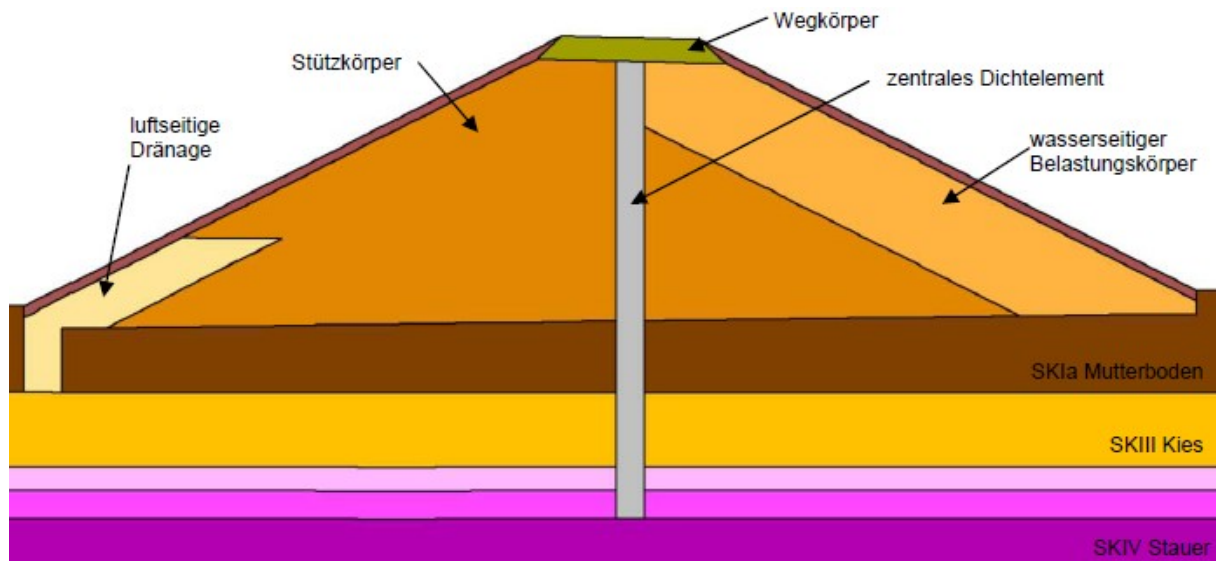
Schematischer Dammbau mit Einbindung des Dichtelementes in den Stauer (entnommen aus [13], Abb.7)
